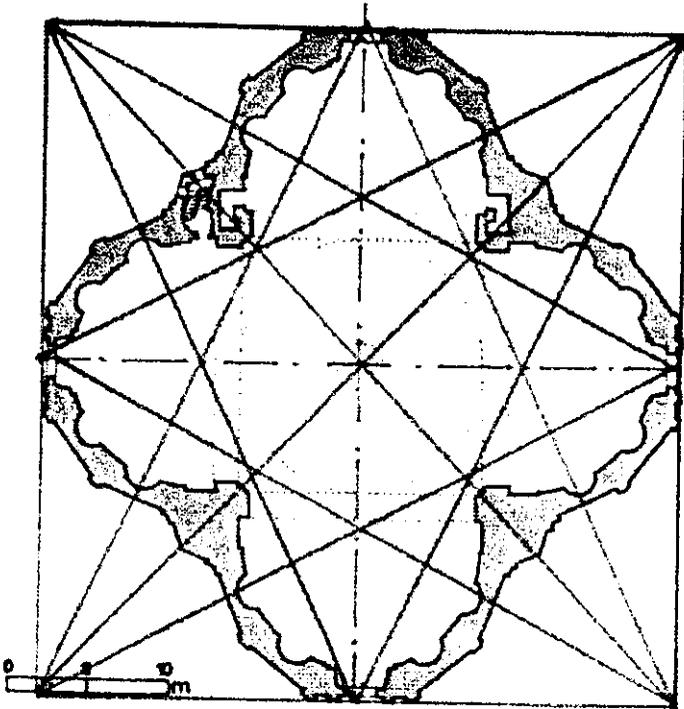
Trazo de la planta de Santa María de la Consolazione (Todi)
